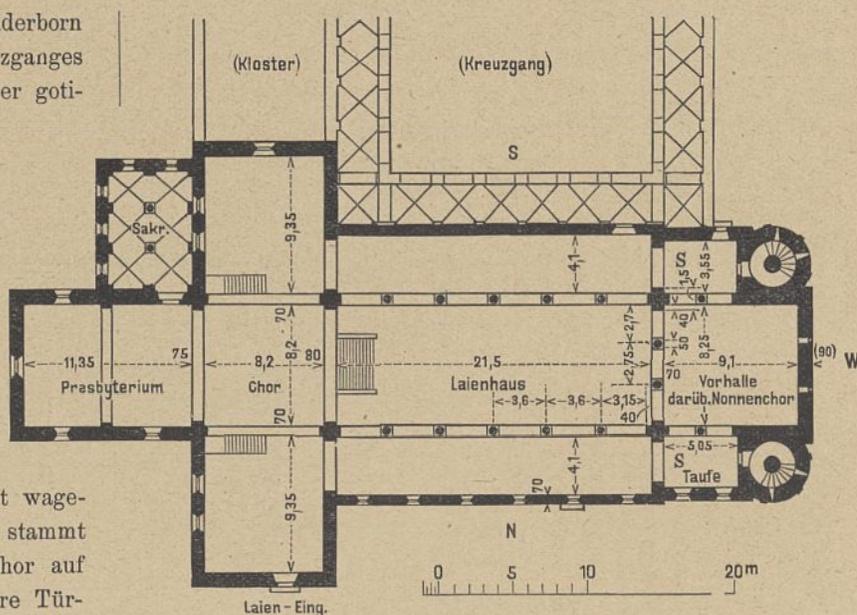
Rekonstruktion des basilikalen Grundrisses (um 1130).
